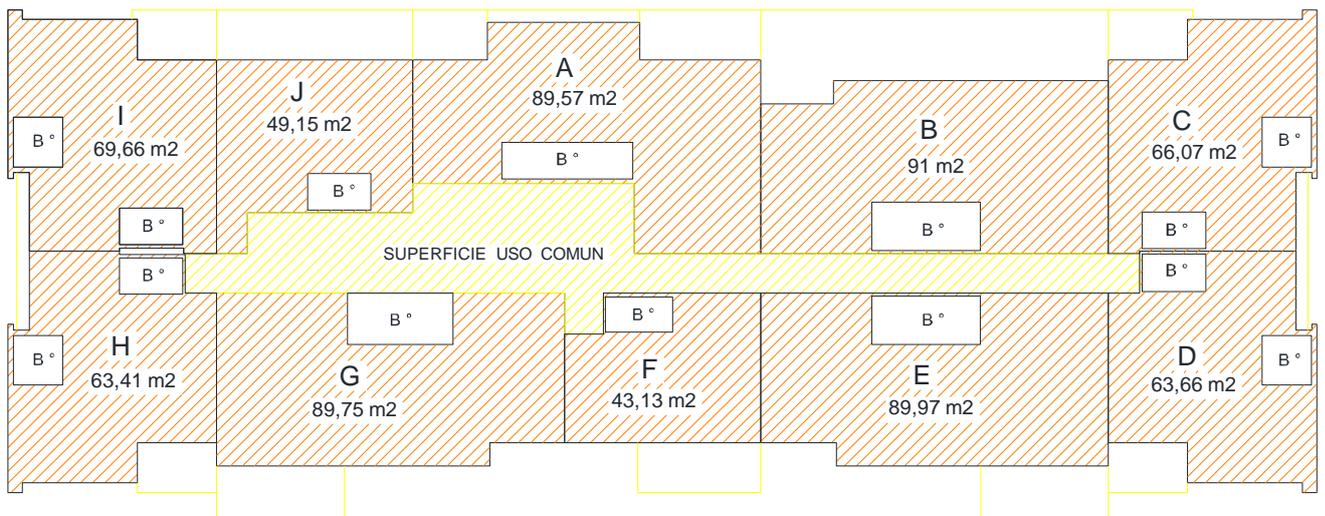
PLANTA SEGUNDO PISO
